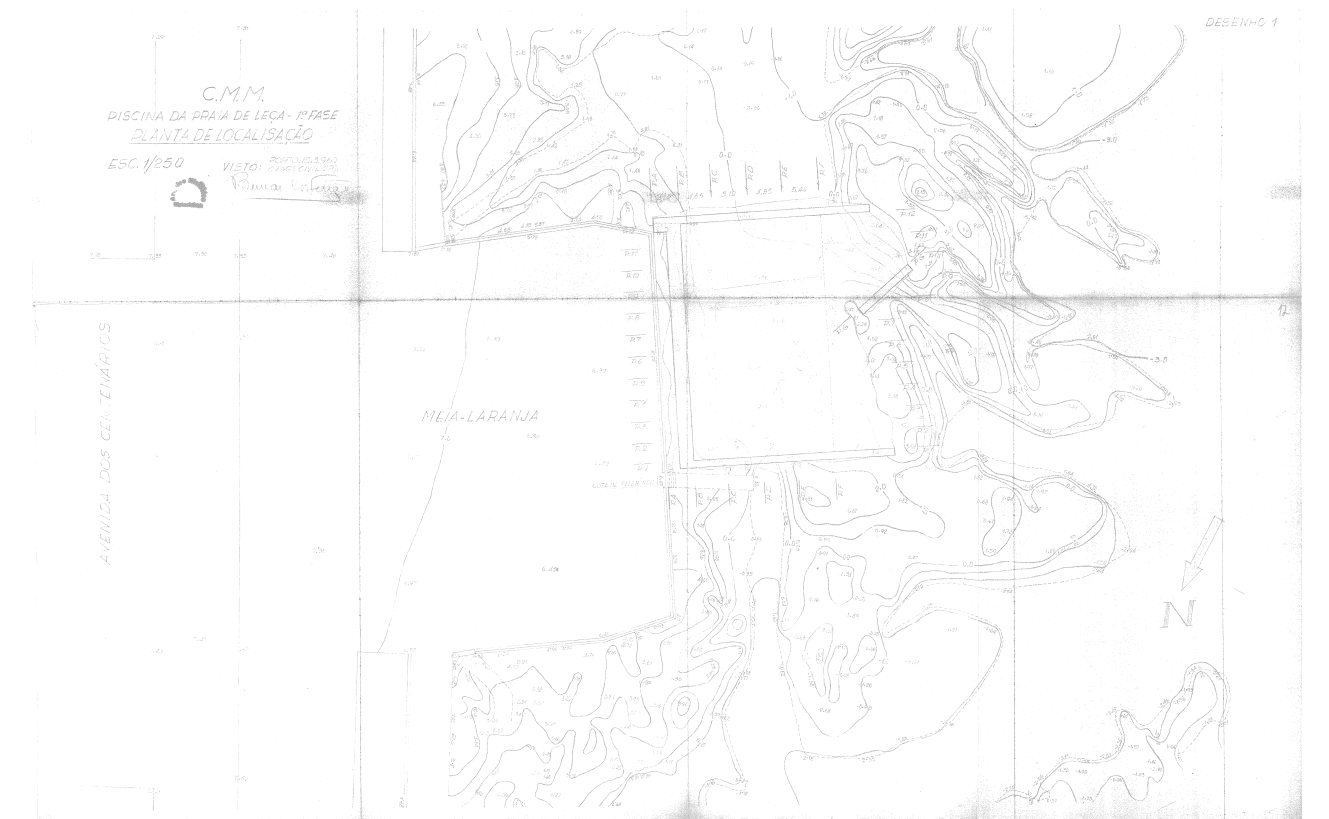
Planta de localização da Piscina de Leça da Palmeira (1961) - Álvaro Siza Vieira
